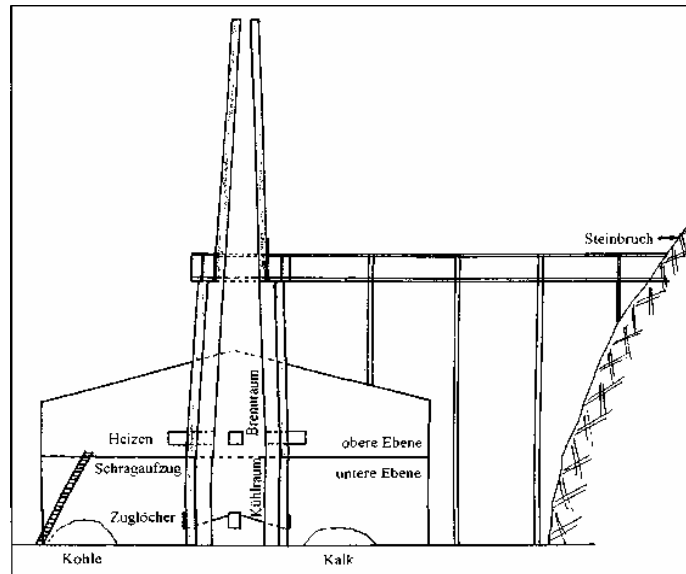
Rekonstruktionsversuch des Anfang der sechziger Jahre abgerissenen Schachtofens, soweit es uns aufgrund der Interviewangaben möglich war.
